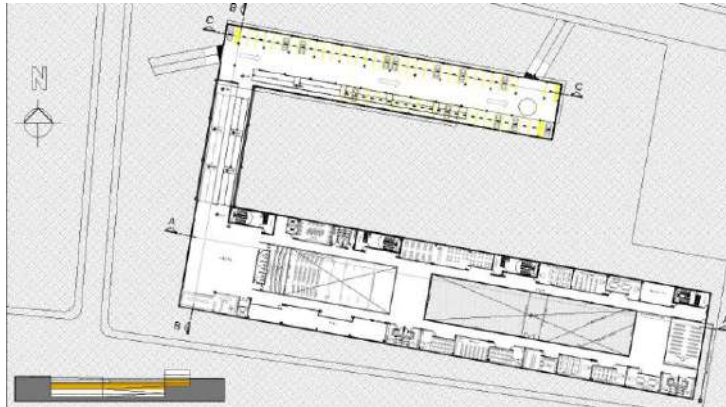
Planta do segundo pavimento e a sua ligação com o estacionamento através das rampas subterrâneas.
